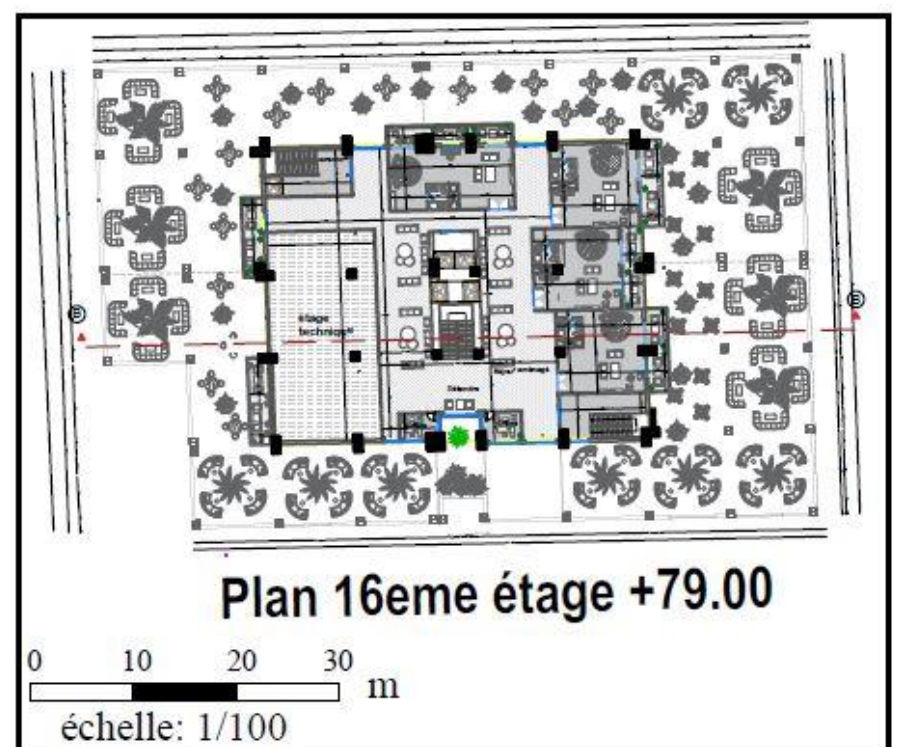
Plan de 15-16 Emme étages+74-79.00/Source : Traiter par l'auteur.
